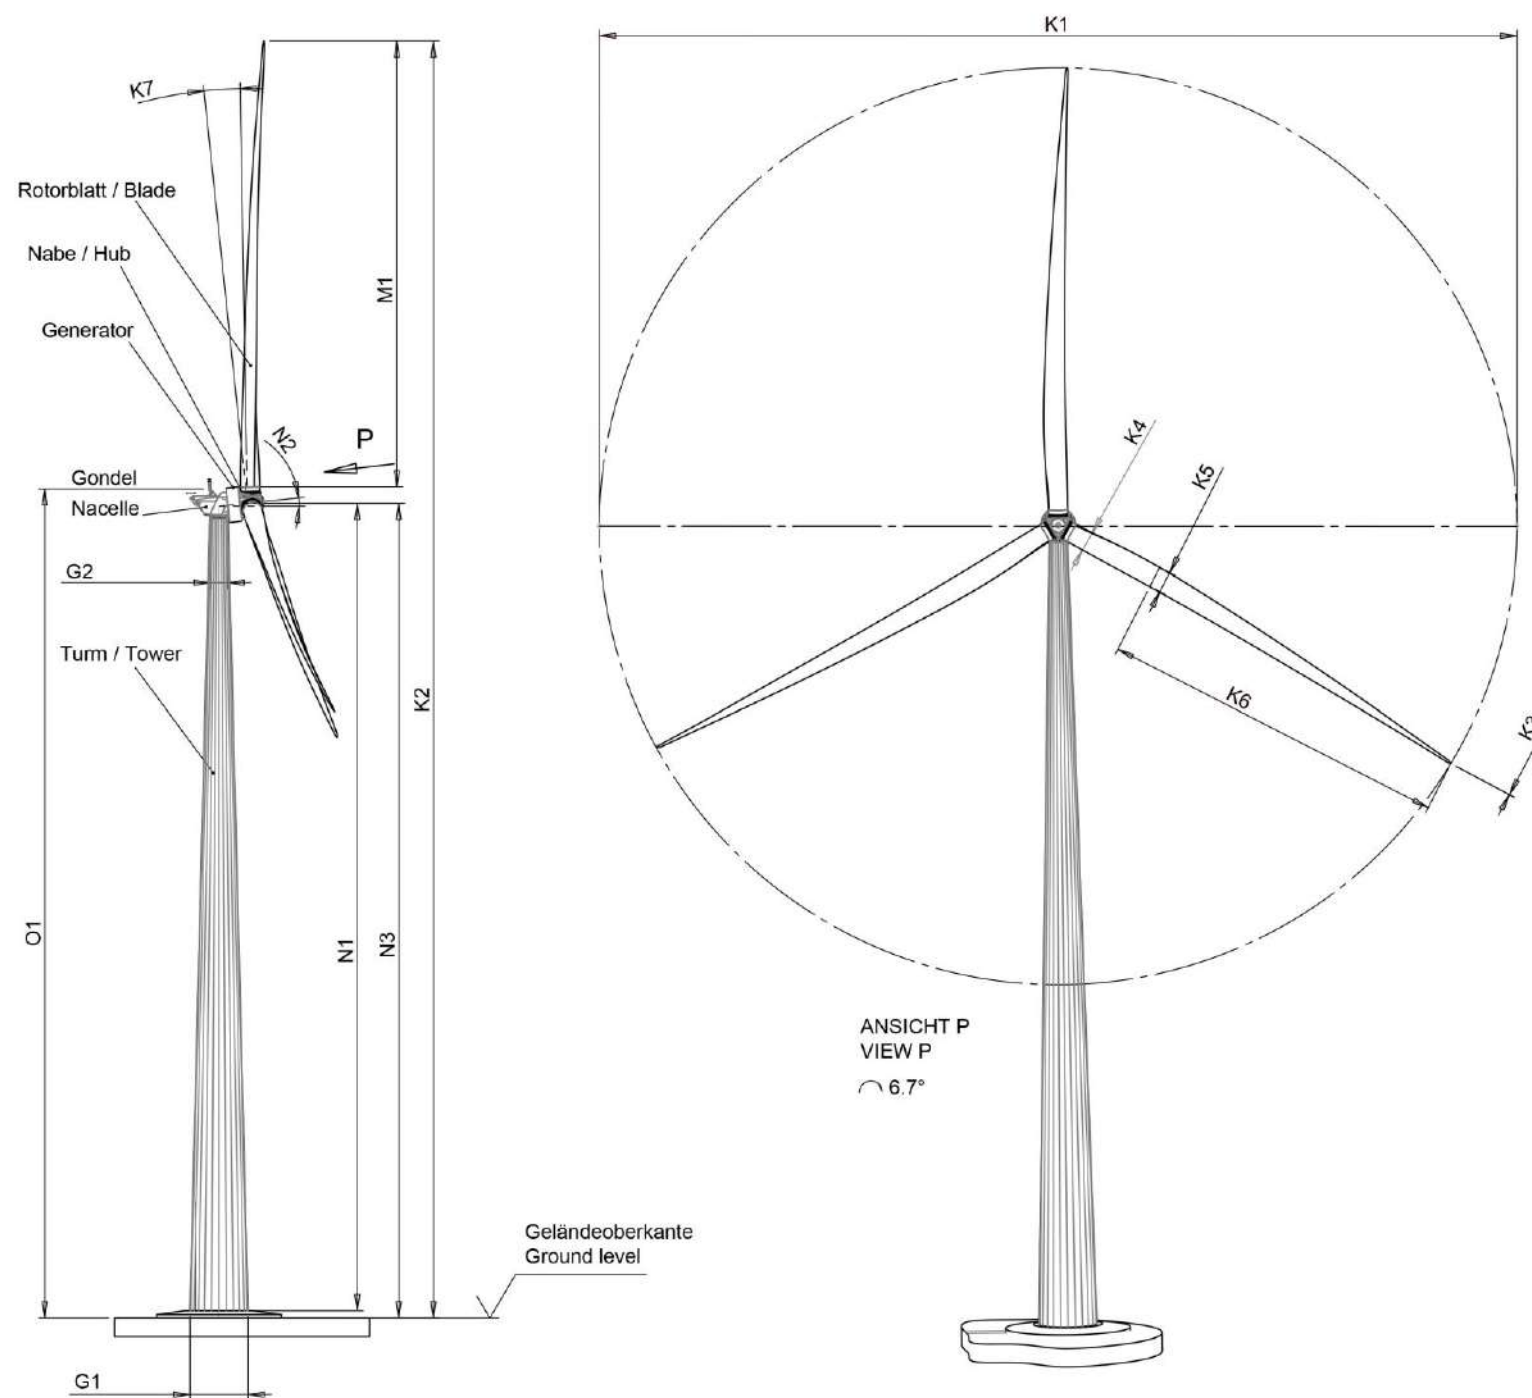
Plans de façade de l'éolienne E-160 (Source : Enercon)
